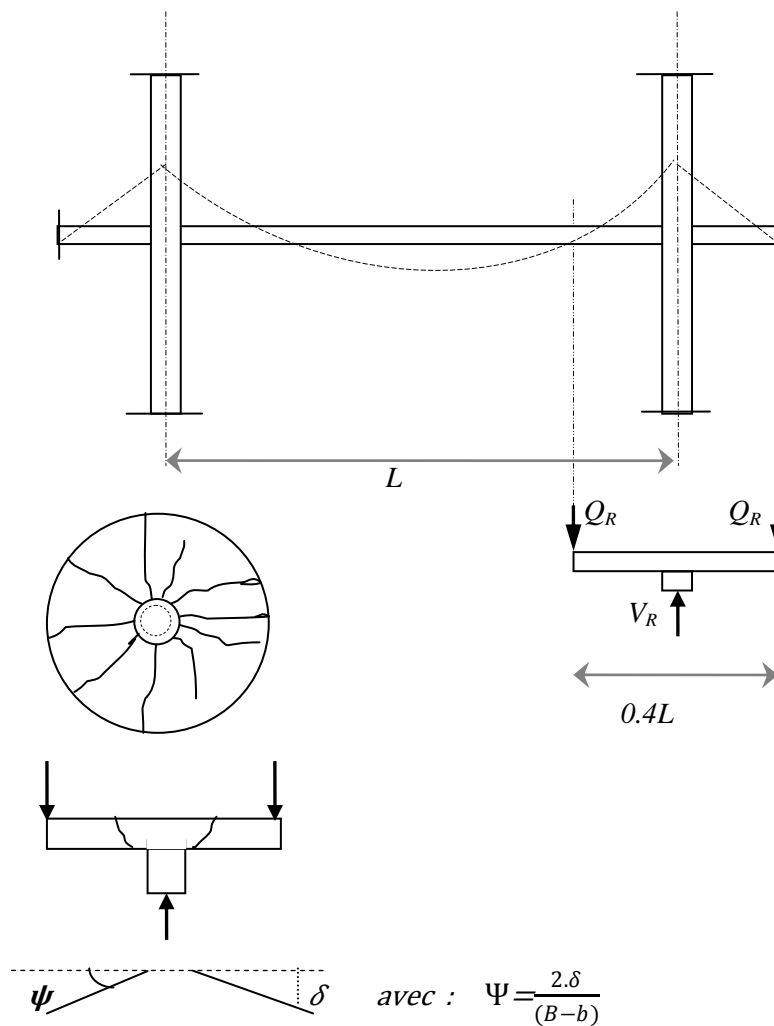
Rupture par poinçonnement d'une dalle en béton armé
